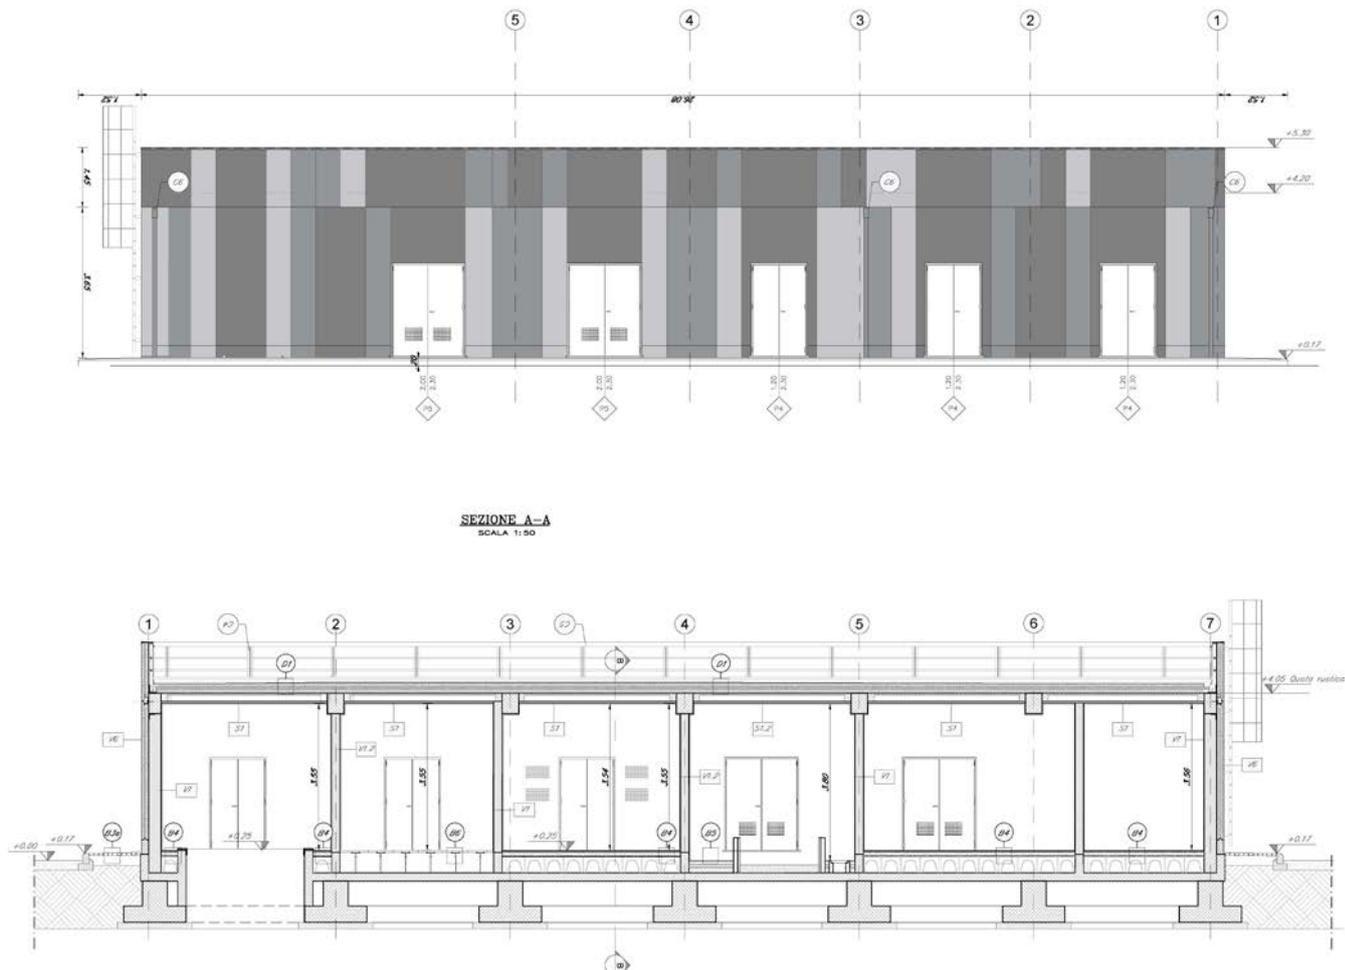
Prospetto e Sezione Fabbricato Imbocco galleria
